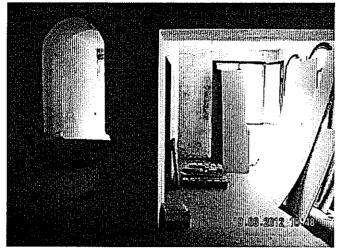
Stanza 8- Vista parete lato stanza 10 e secchiaio storico in pietra.
